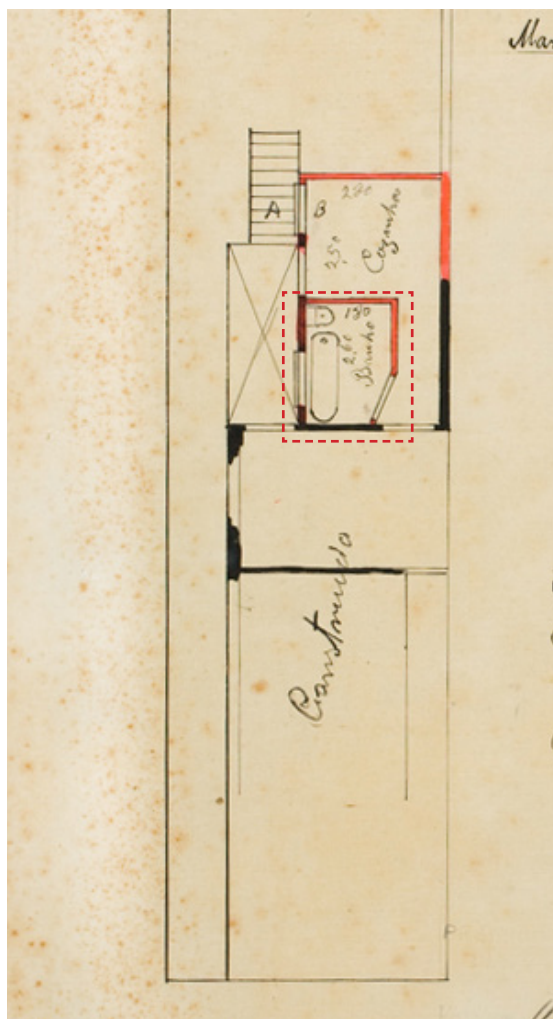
Planta de reforma com acréscimo do banheiro.
